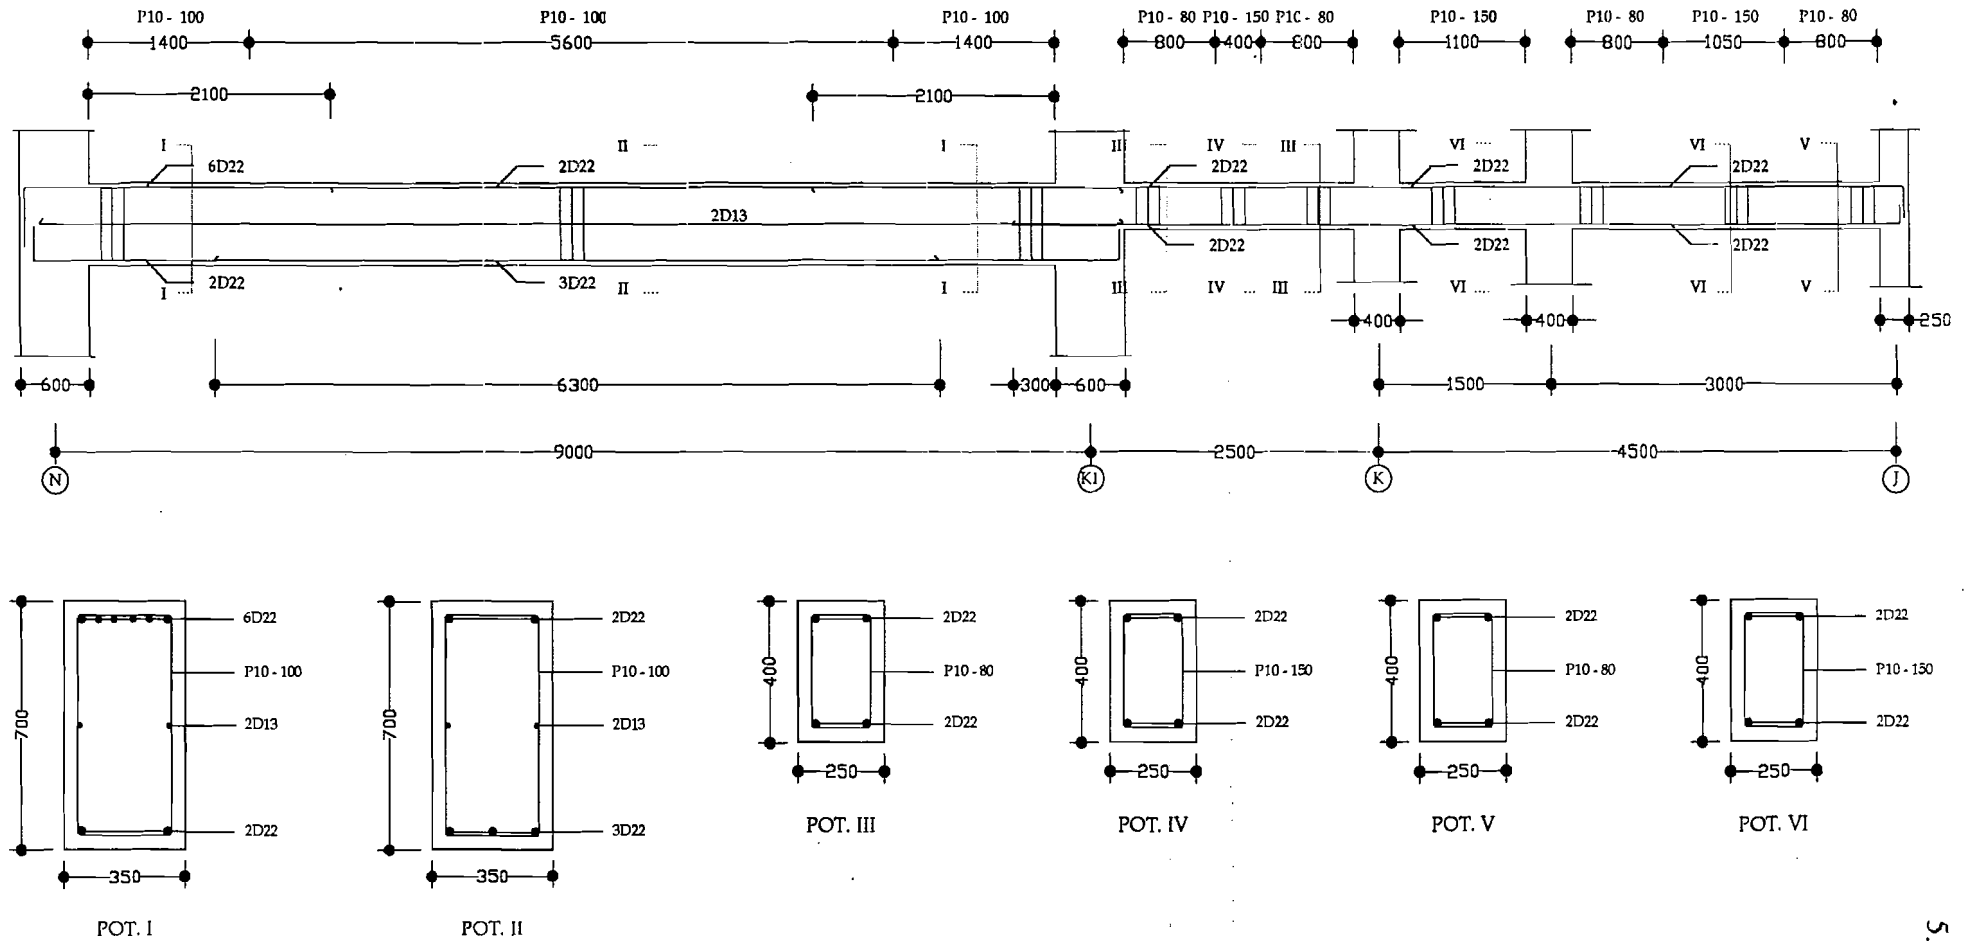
Denah Rencana Balok Induk Lantai 2
